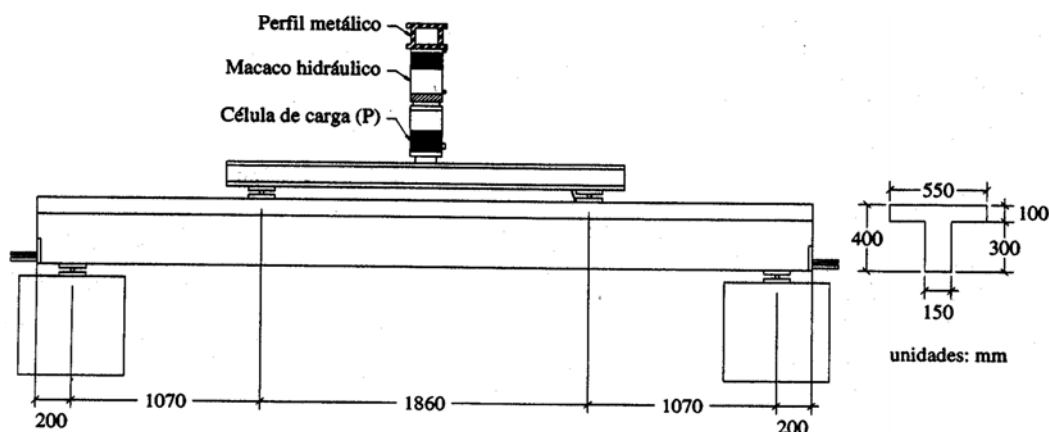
Esquema de carregamento e geometria da viga; adaptada de Silva Filho (2001).
